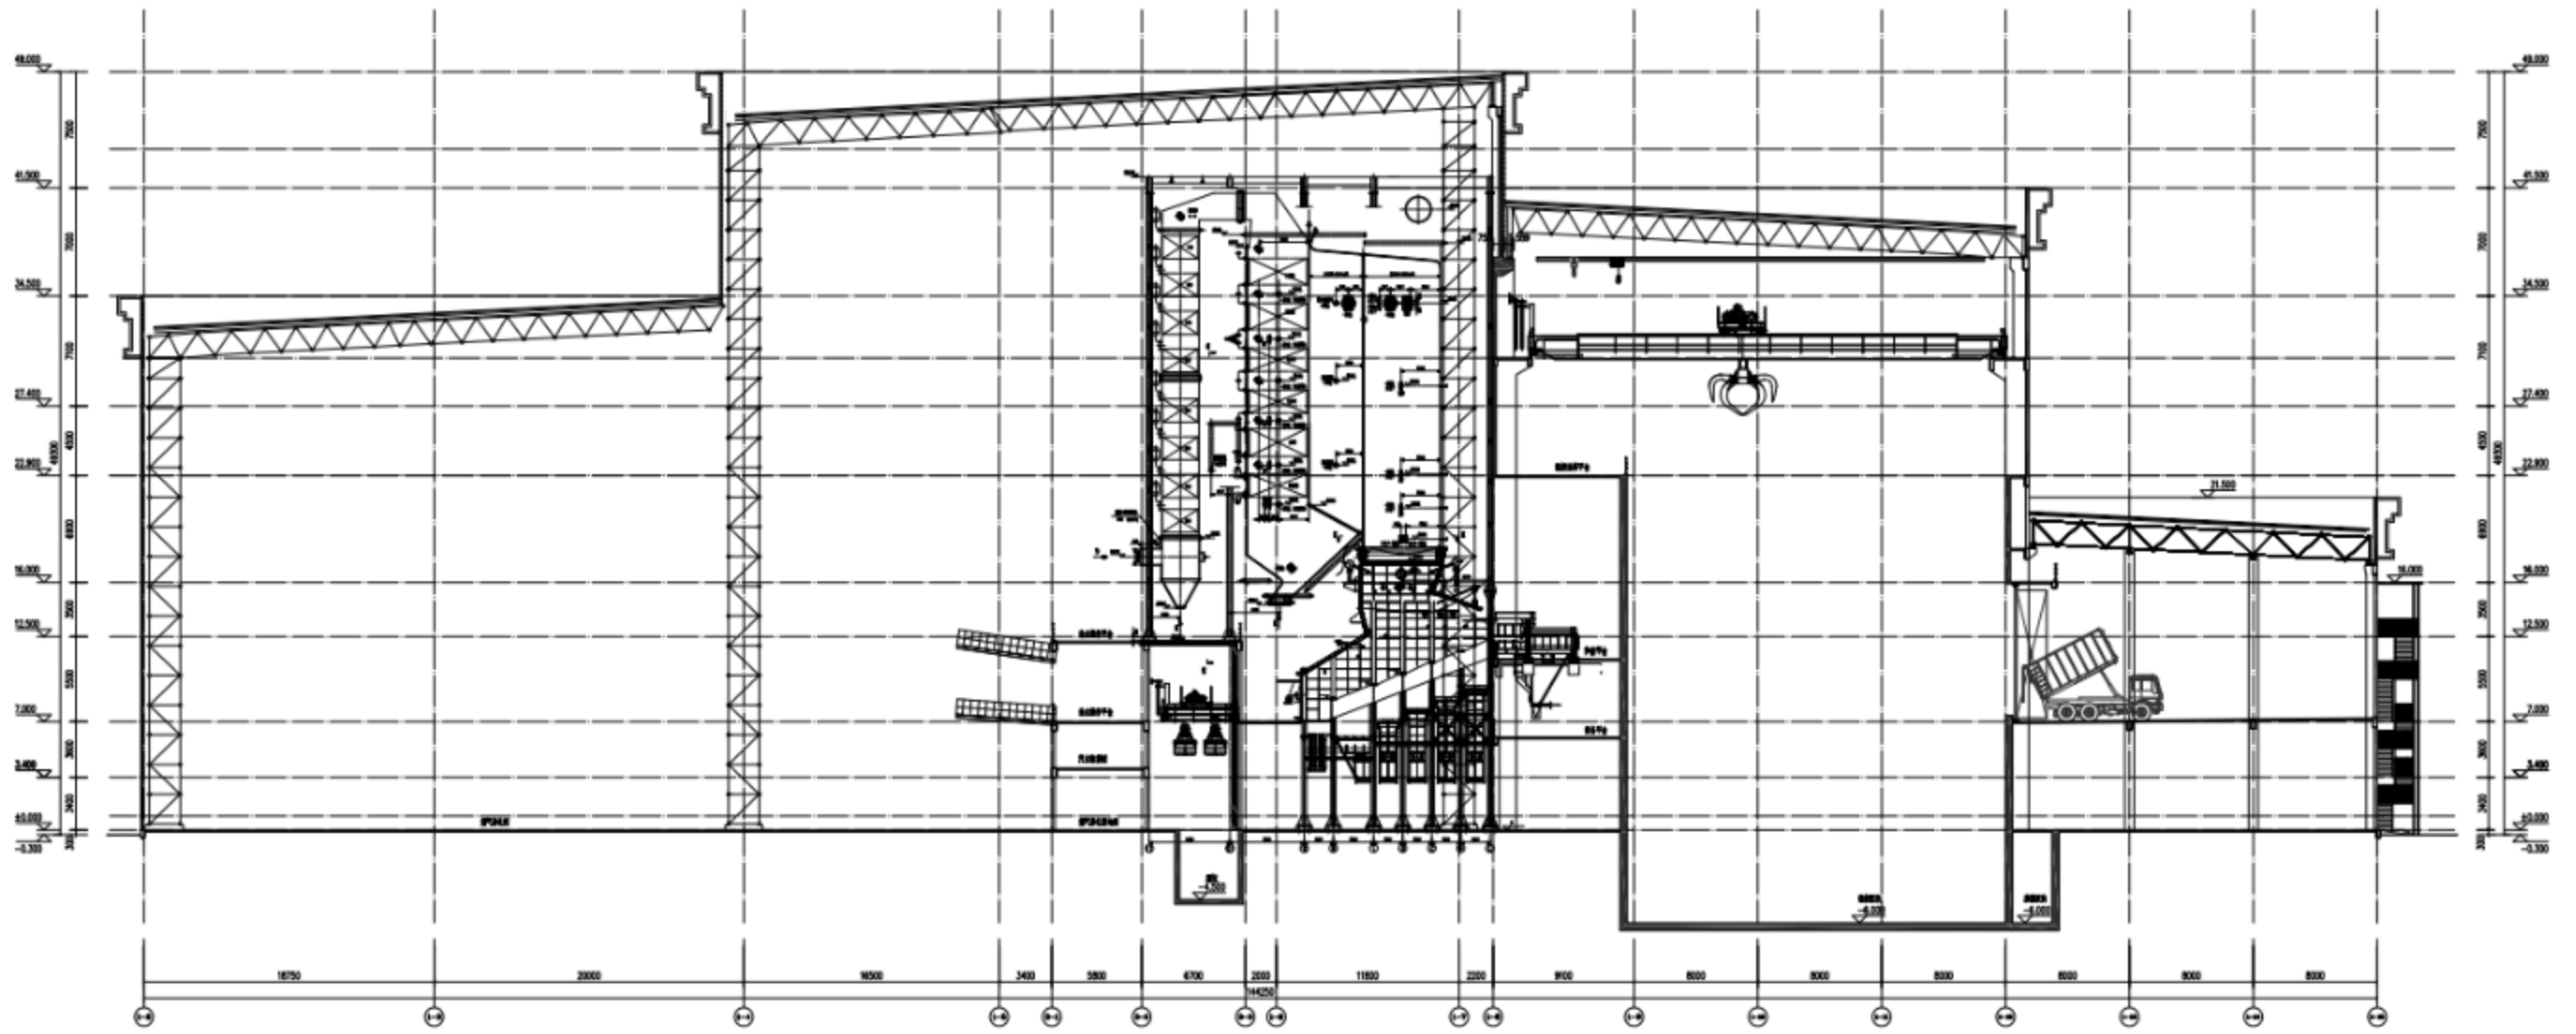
垃圾卸料、垃圾贮存剖面图 1
